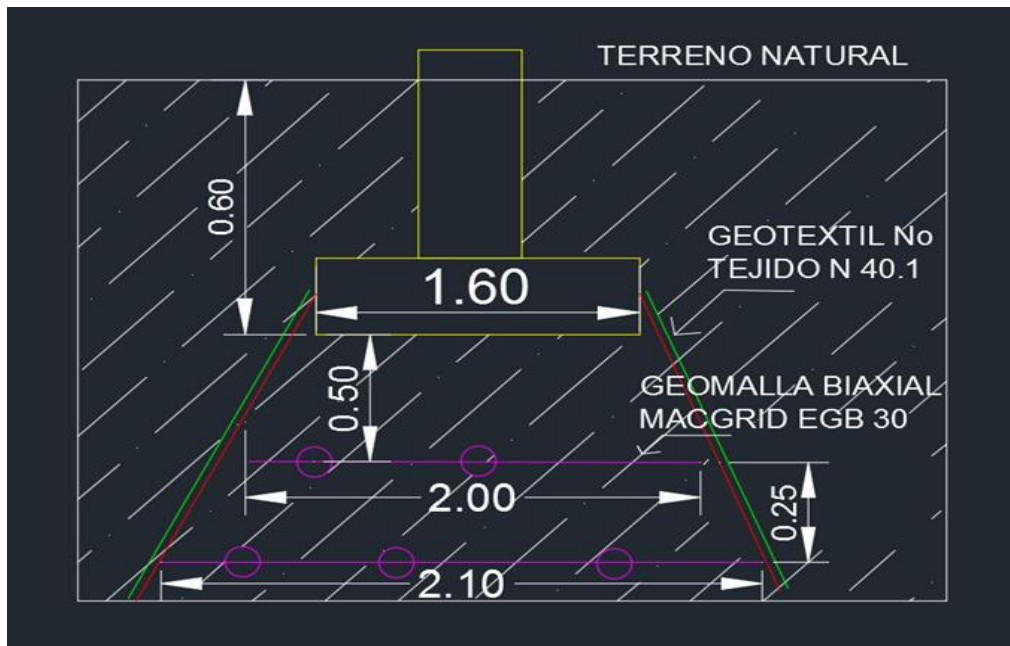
Diseño de cimentación con refuerzo de geomallas para zapata N°5
